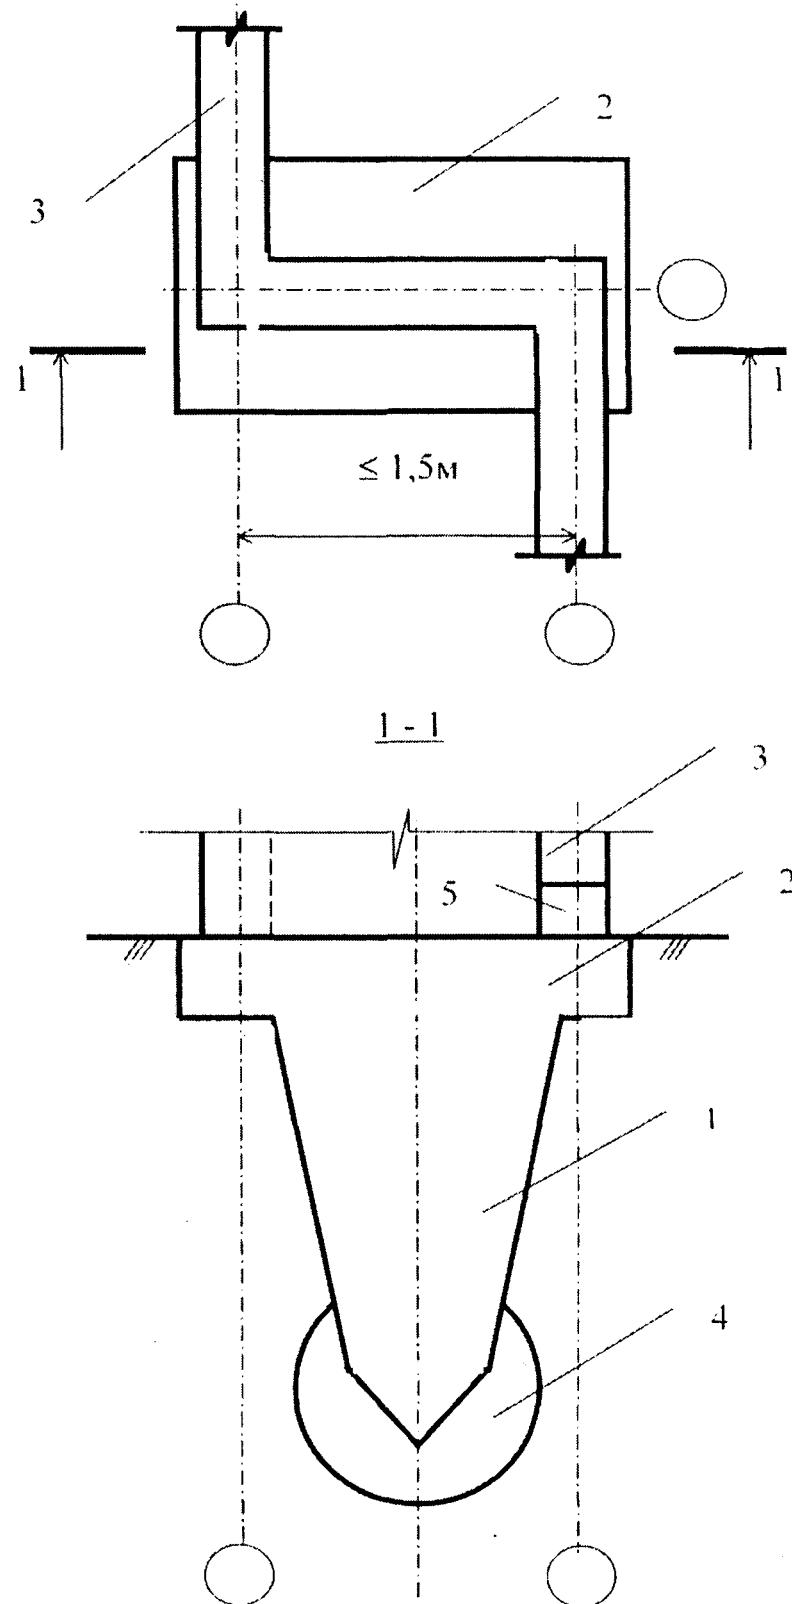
Схема фундамента в вытрамбованном котловане на месте пересечения стен.
